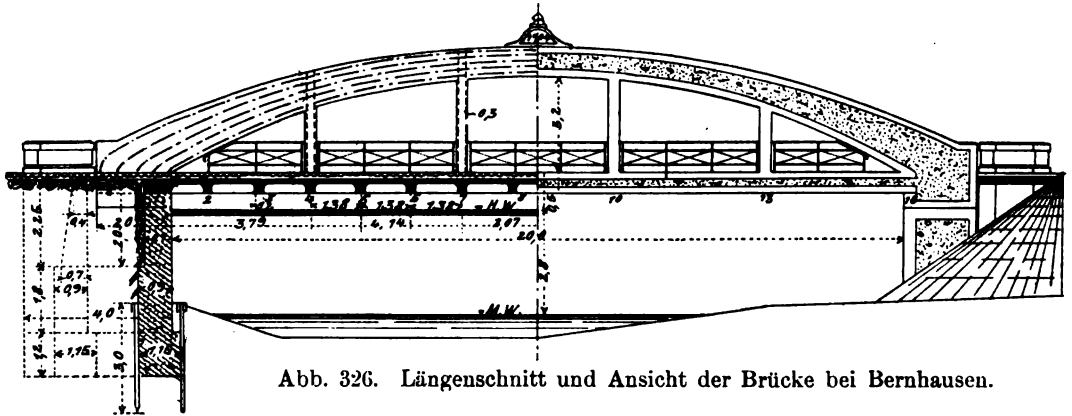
Längenschnitt und Ansicht der Brücke bei Bernhausen.
